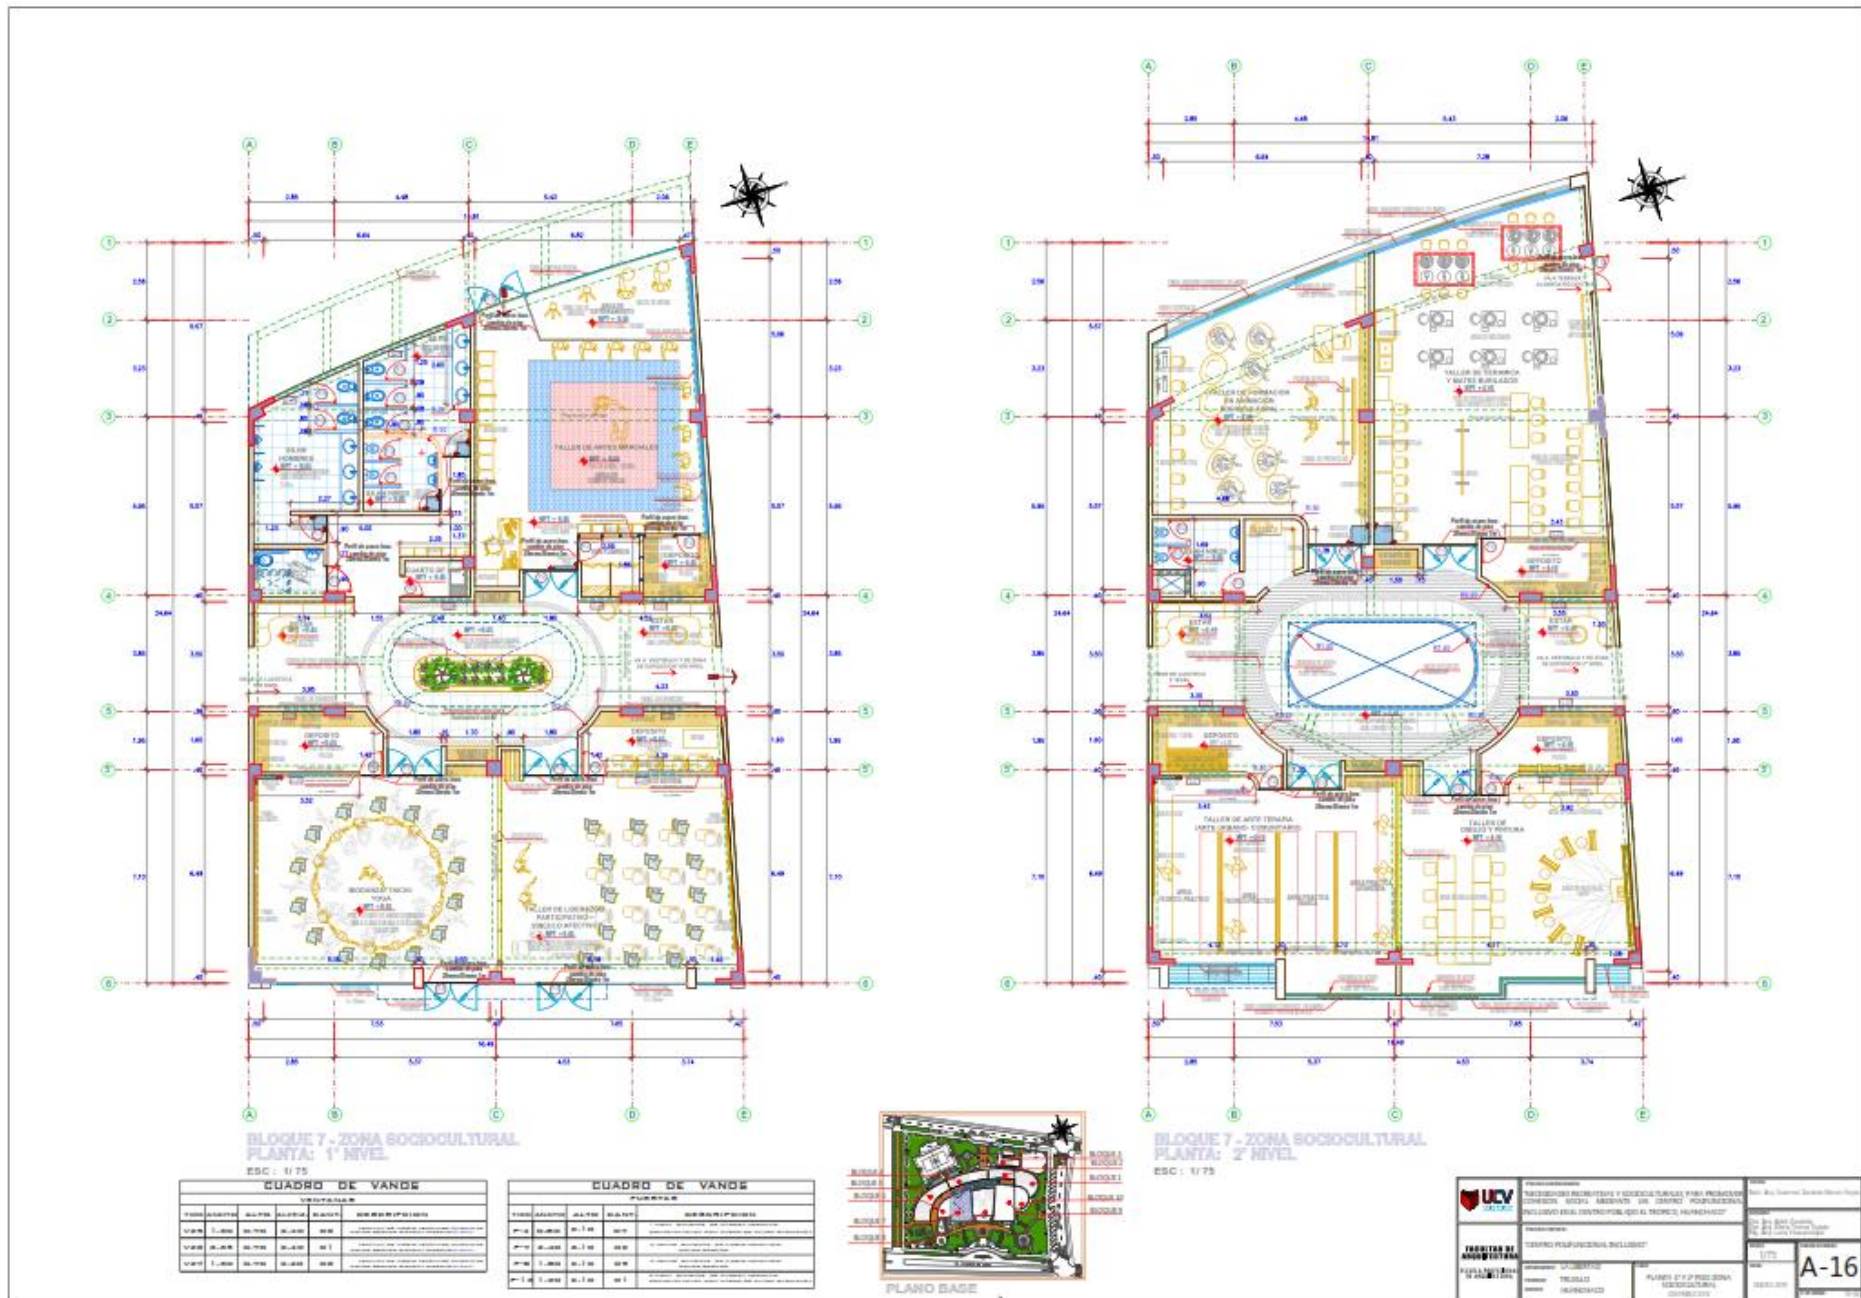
Desarrollo del bloque N° 7, Zona sociocultural. Planta 1° y 2° nivel: A-16. Fuente: Propia (2018) 214
